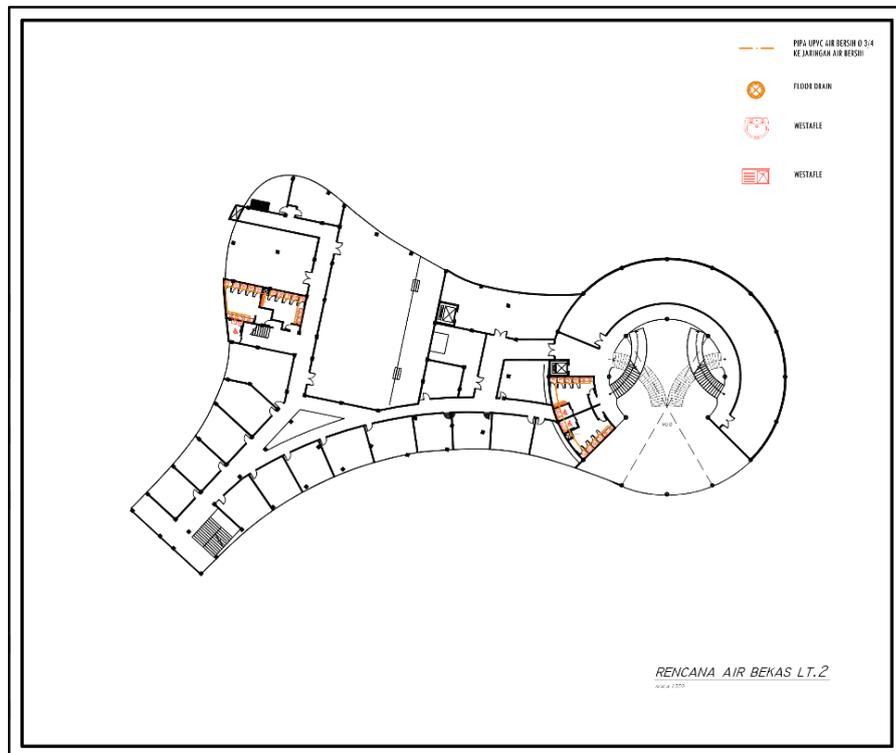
Denah Rencana Air Kotor Lantai 2
